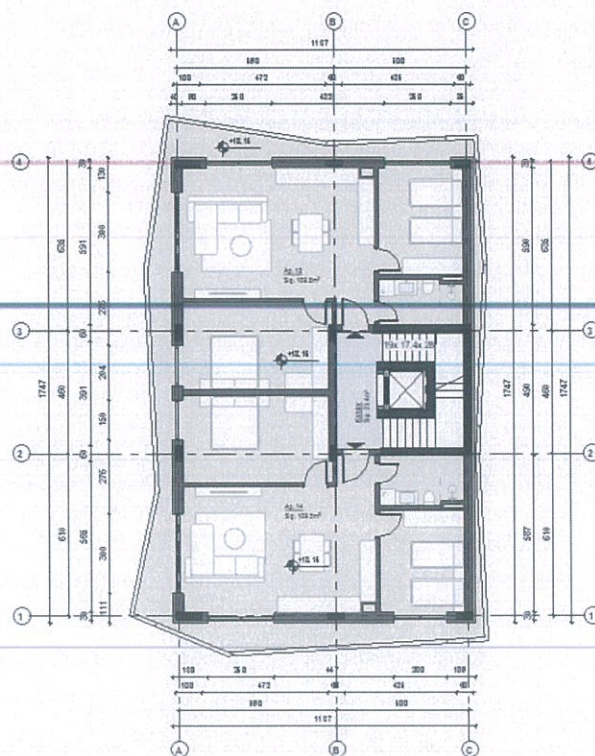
Planimetria e katit +5 me sipërfaqe 242.7 m² (banim)
